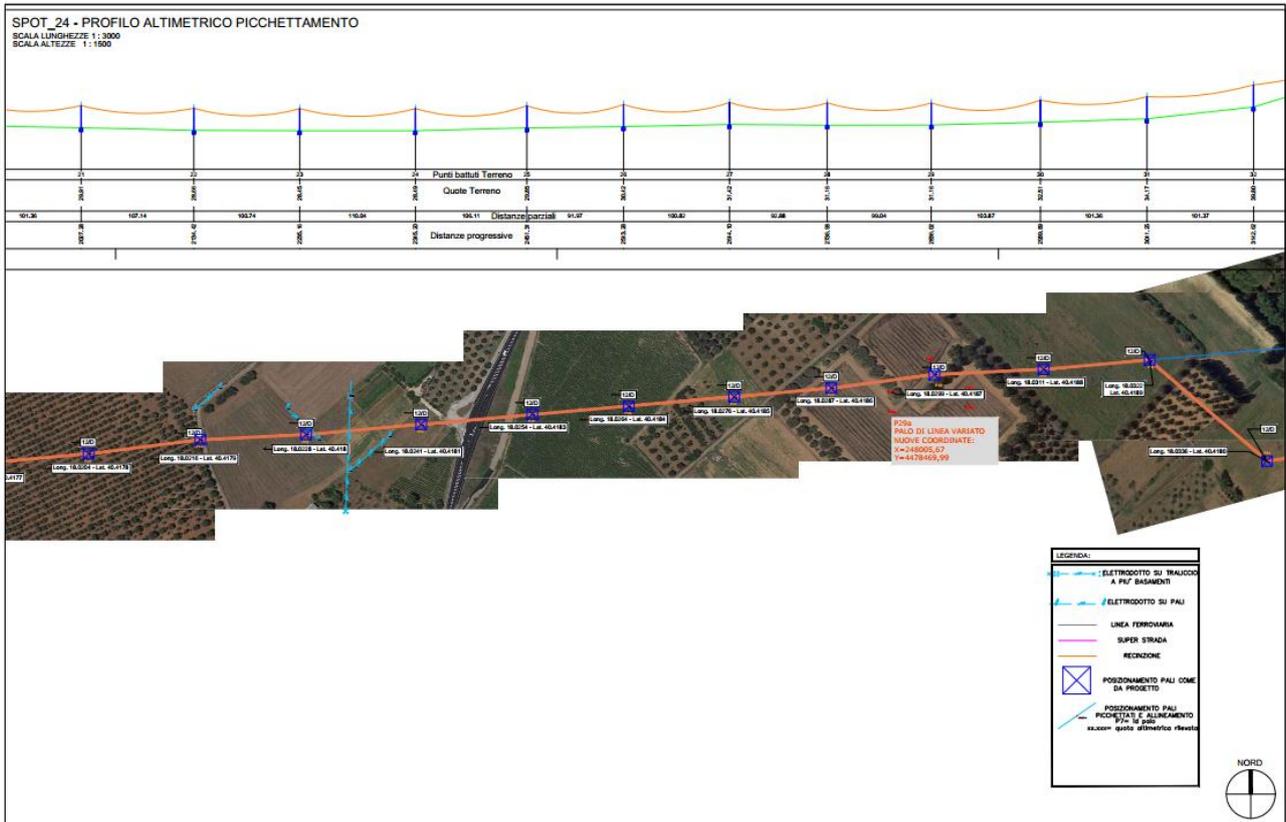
Profilo pianoaltimetrico attraversamento SS16
